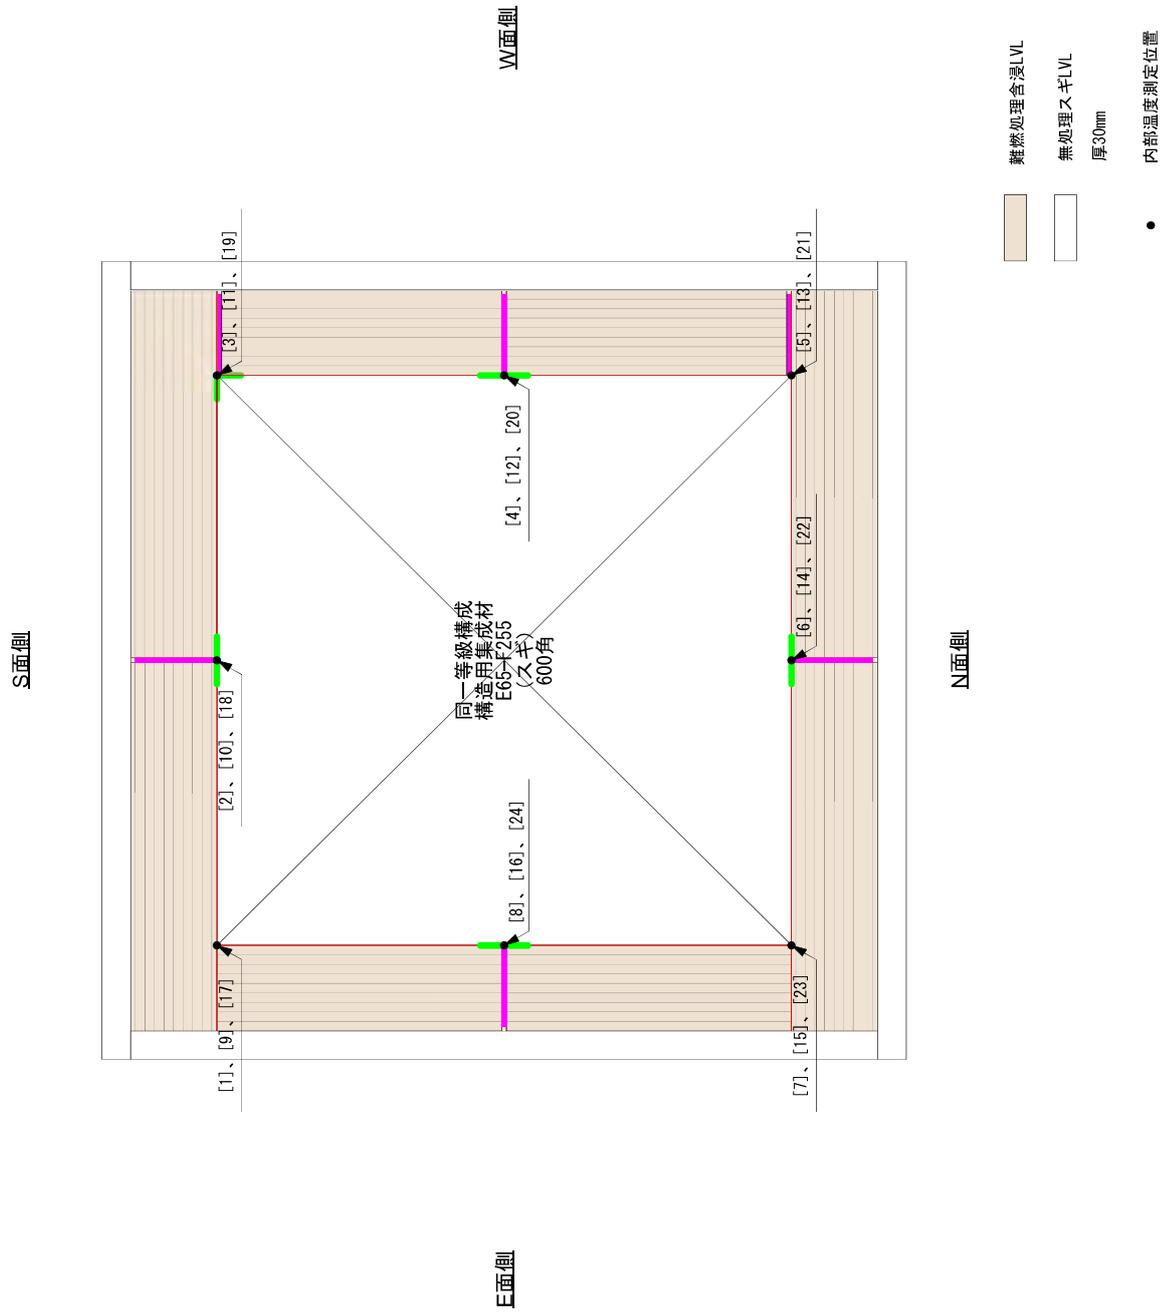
試験体Bの構造・内部温度測定位置(寸法単位: mm)
